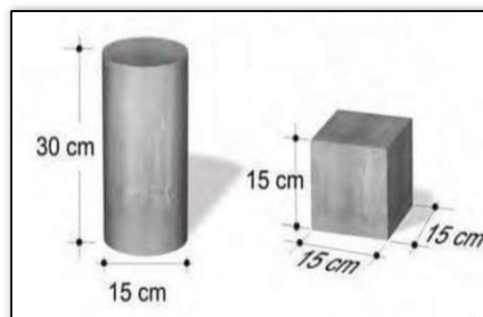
Dimensions des éprouvettes cylindriques et cubiques selon l'EC2
